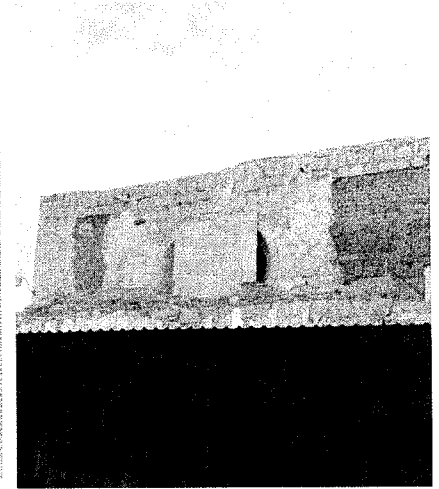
Vista lateral nor-poniente muro del teatro colindante con estacionamiento
